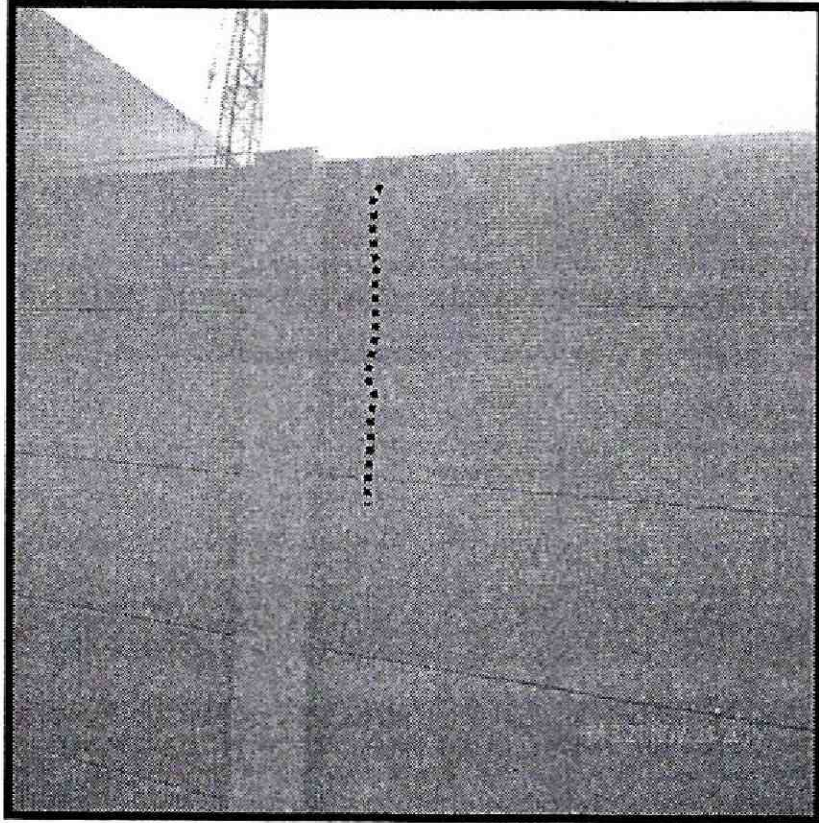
Vista en planta del muro que divide la obra aledaña con la zona verte, del predio ubicado en la Carrera 50 No 104B-68, en el Sector Catastral Estoril, de la Localidad de Suba.
